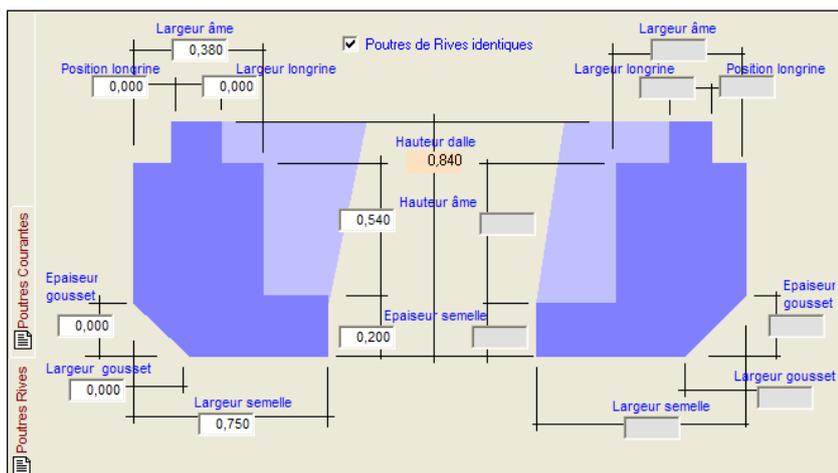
Géométrie des poutres de rive (ouvrage n°2)
